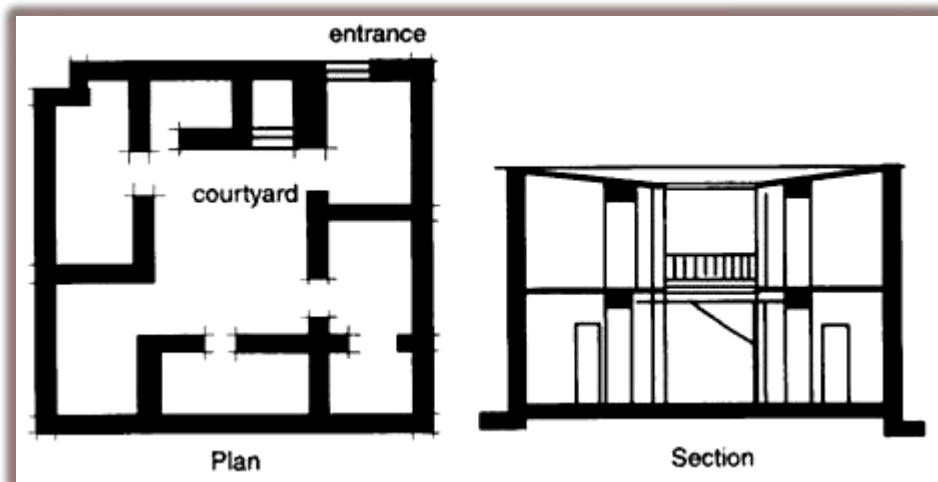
plan et coupe d'une maison de Ur, Mésopotamien
